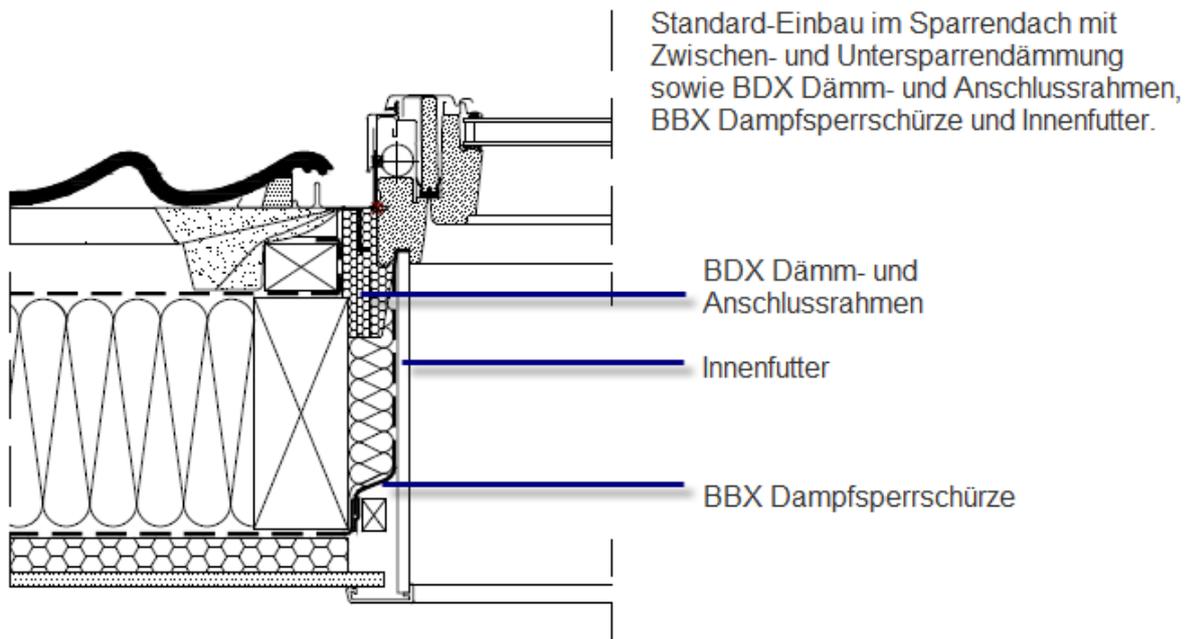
und 2: Einzeln eingebaute Dachfenster
